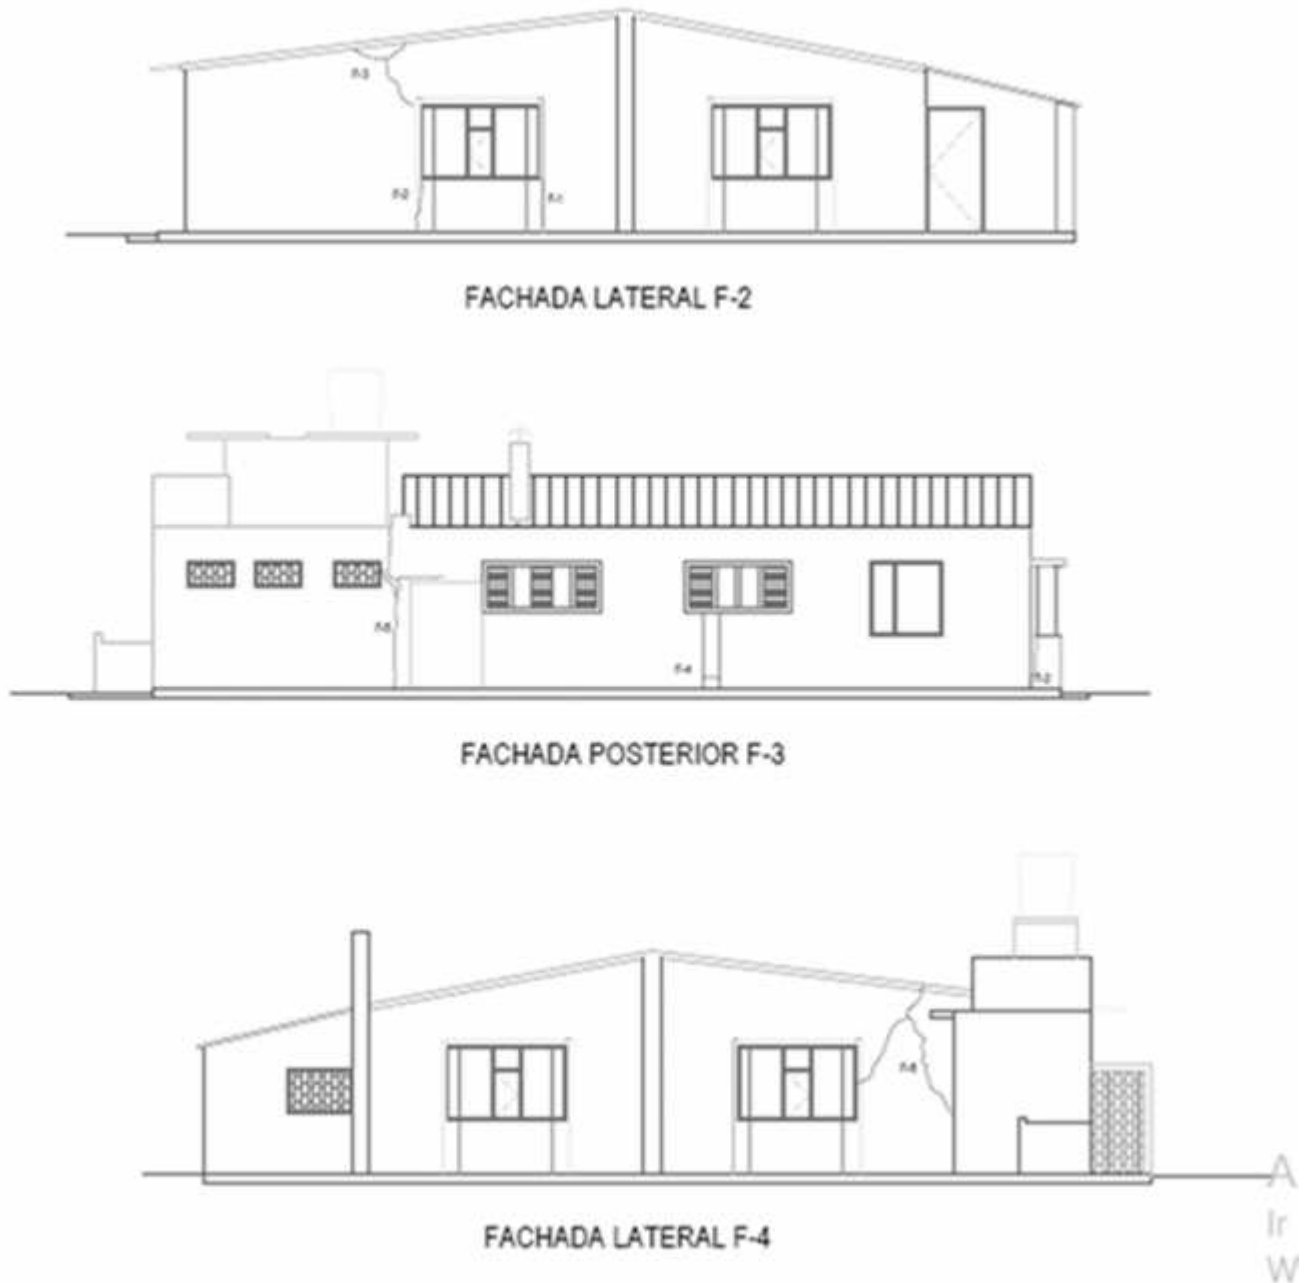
Localización de fisuras y grietas en los cortes
